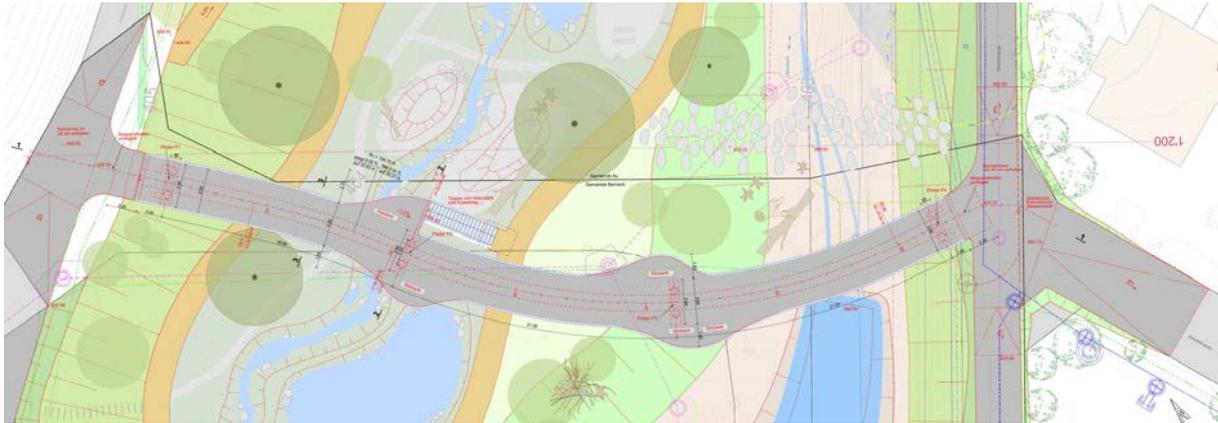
Horizontale Linienführung des Kobelstegs, Littenbach
